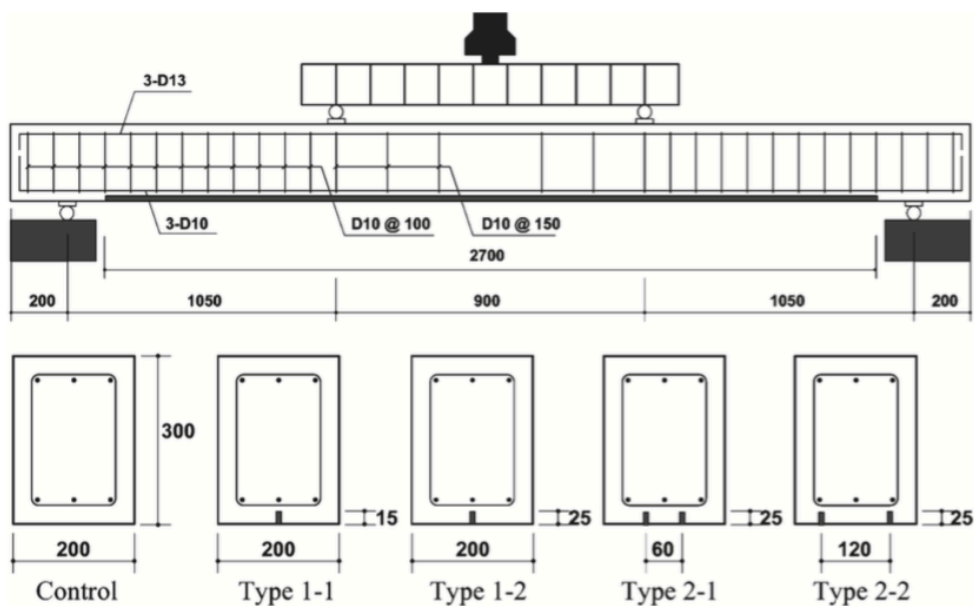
Geometria das vigas (Fonte: Kang *et al*, 2005)
